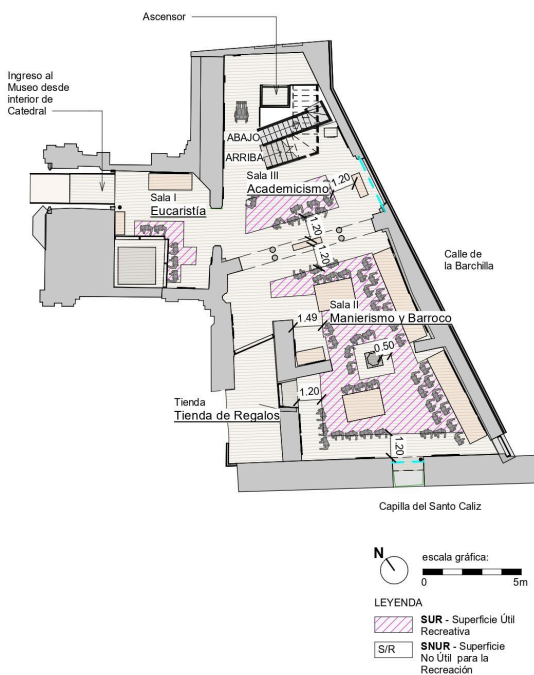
Planta Baja del Museo. Cálculo CCR. Elaboración propia
